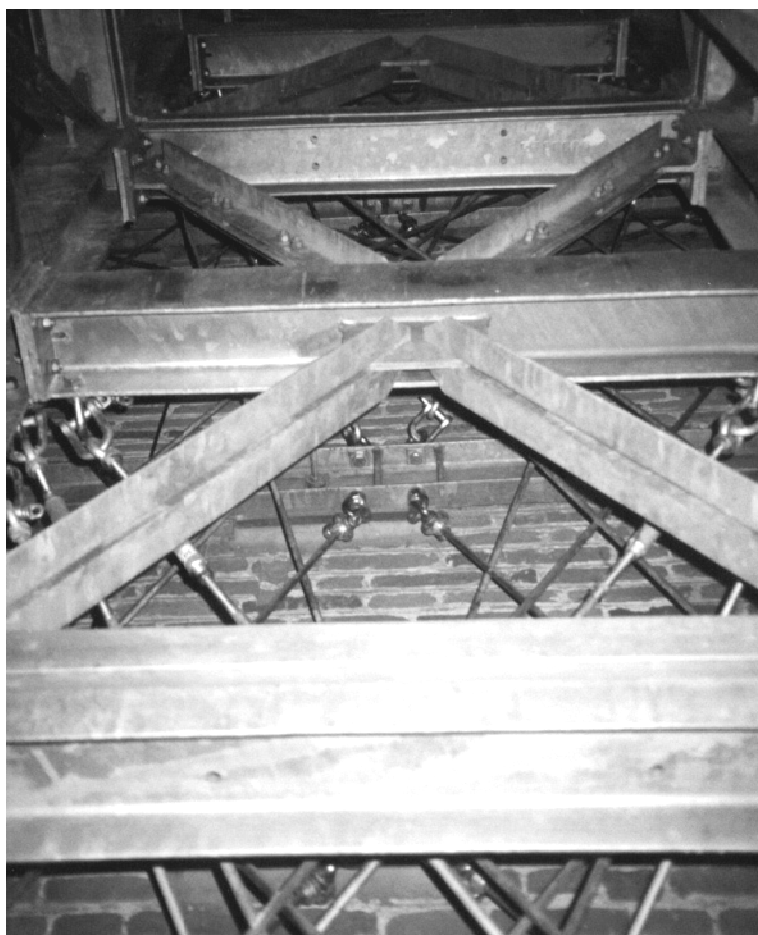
Traliccio metallico e stralli di collegamento con la muratura [19]
